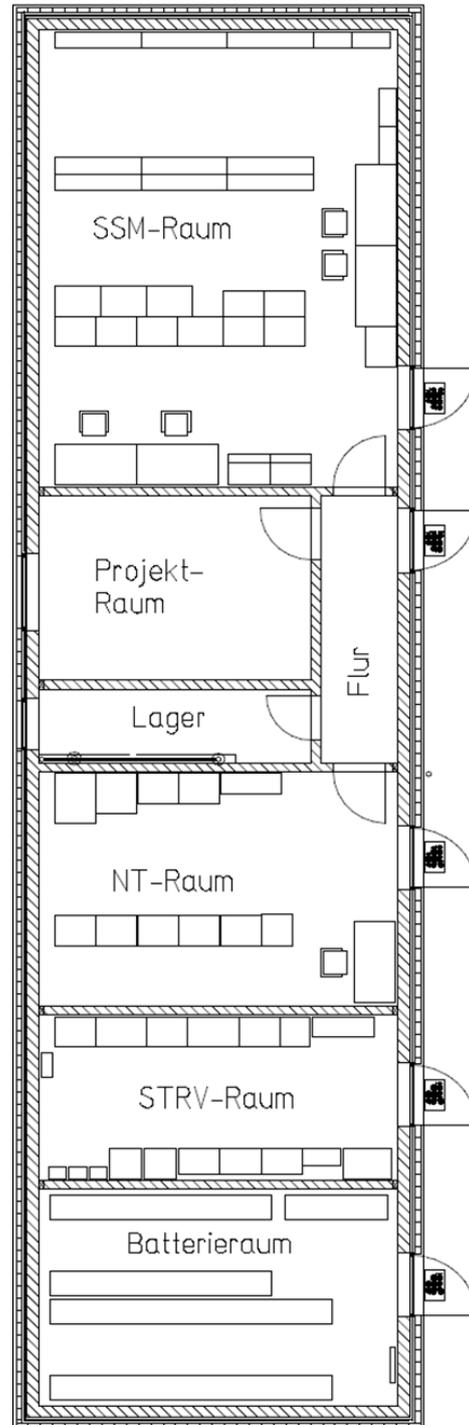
Grundriss mit Funktionsbeschreibung Betriebsgebäude.
